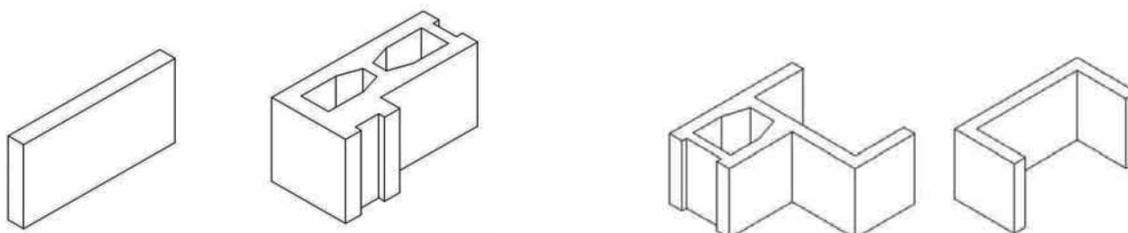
Plaqueta y bloque de esquina/encuentro para mantener el aparejo en determinados muros [izquierda]. Bloques para pilastra de enlace y pilastra sencilla [derecha].
